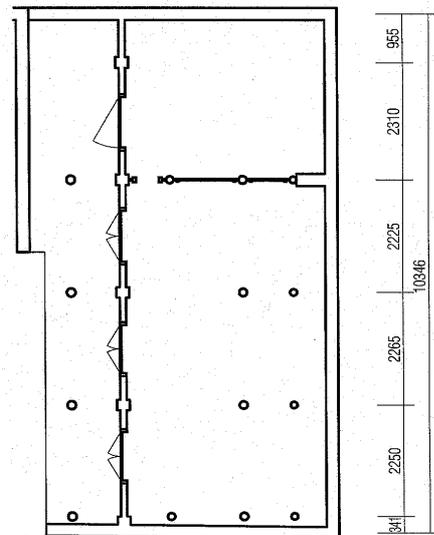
Nguyen Van Truc邸 主屋 平面図 1:150
